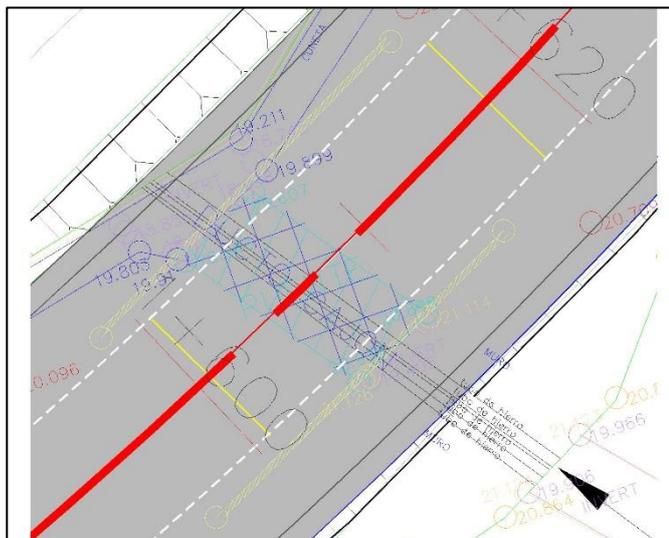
Vista en planta de Alcantarilla en abscisa 1+605.
